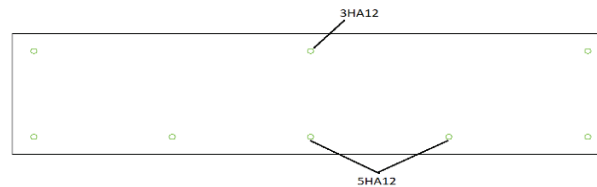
Ferrailage de l'Hourdi Longitudinal
